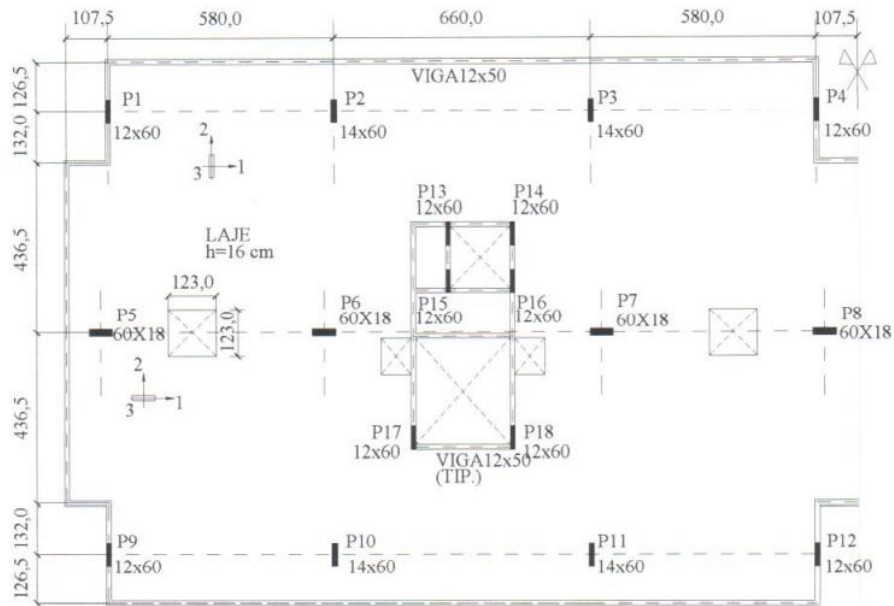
Planta baixa do primeiro exemplo (BEZERRA, 2001) – cotas em cm
